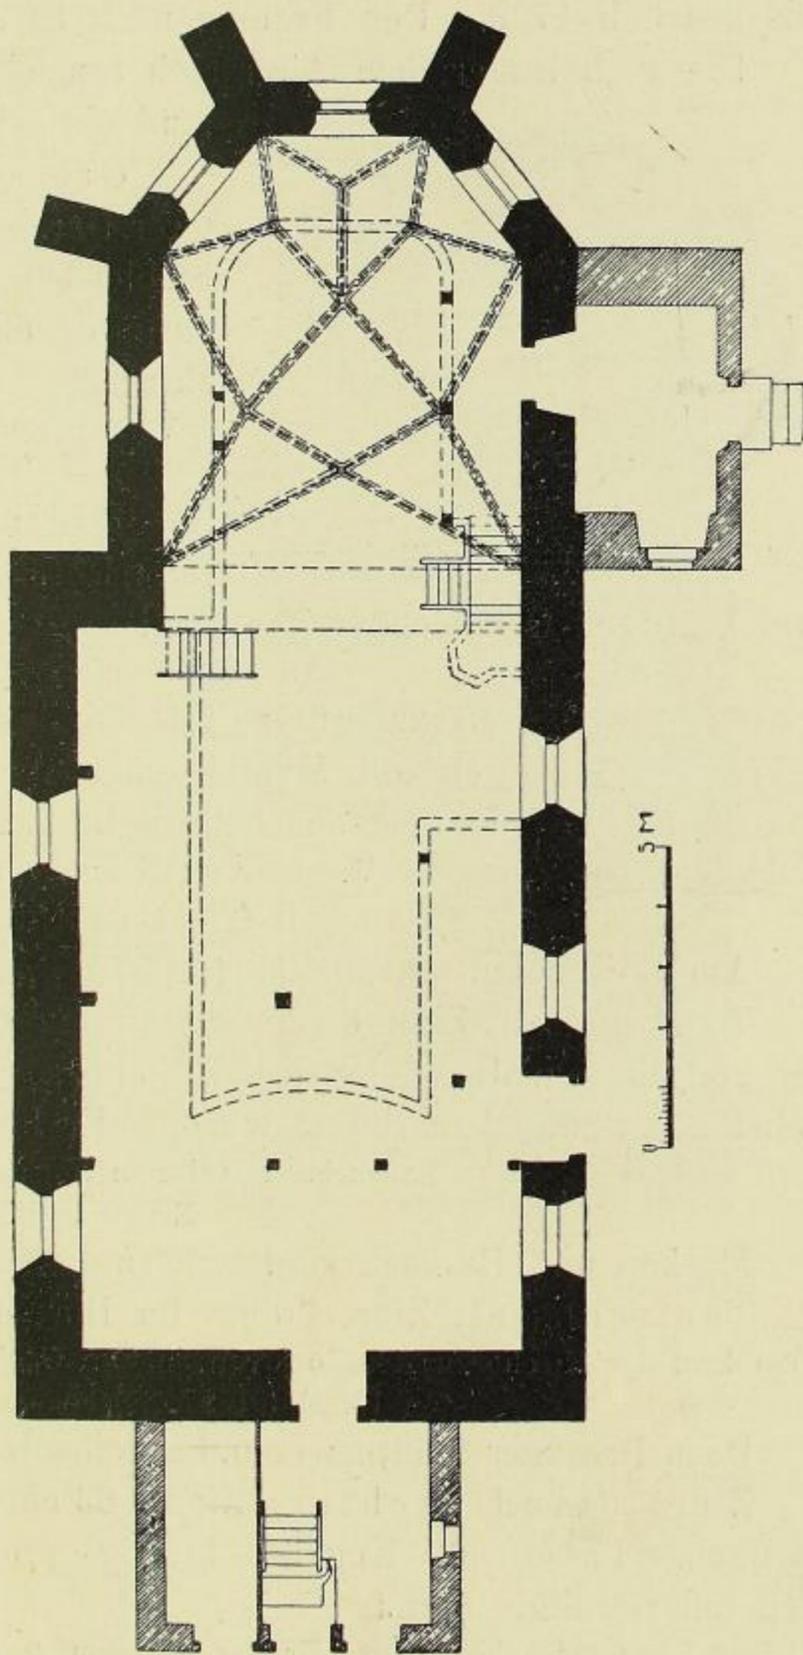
Arnsdorf, Grundriss der Kirche.
